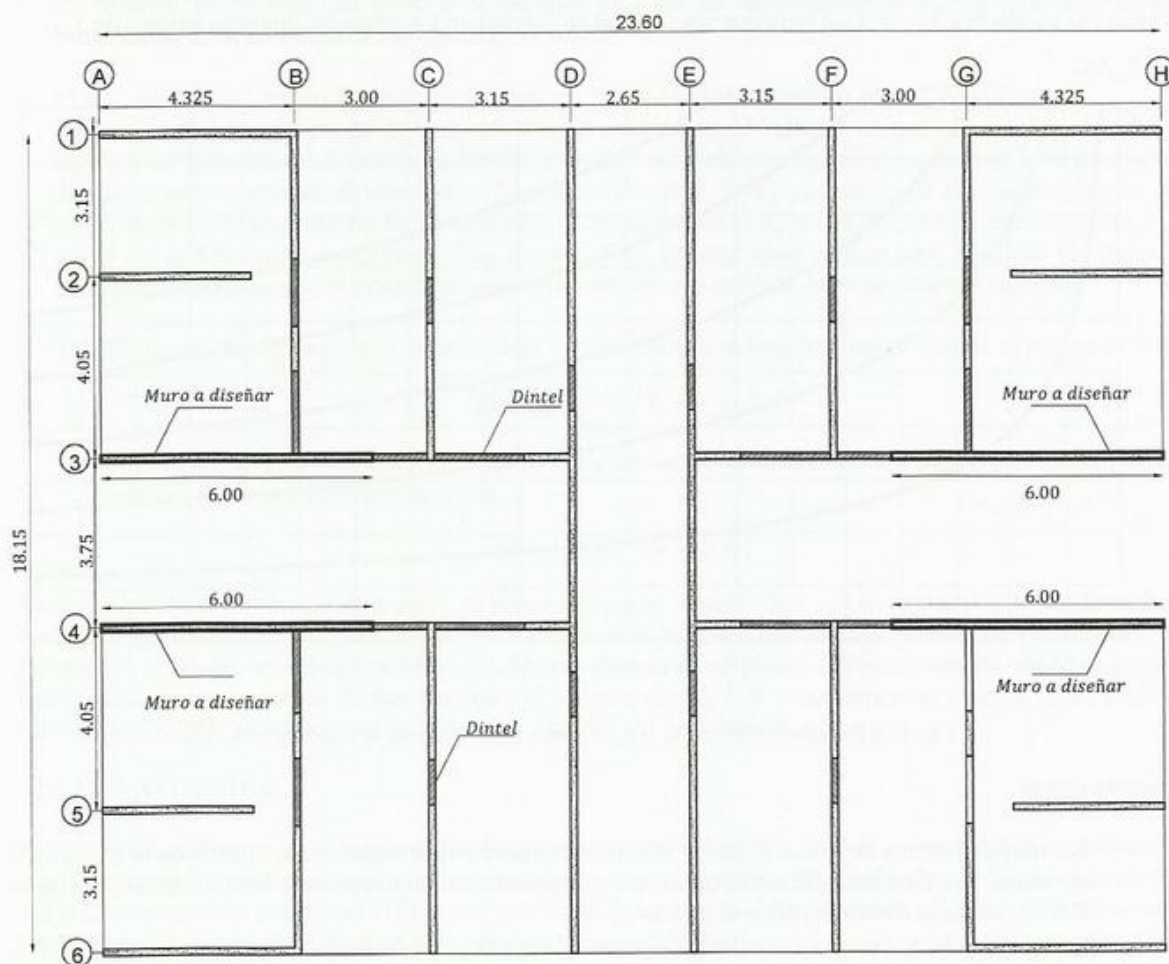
Vista en planta del Edificio del Ejemplo
